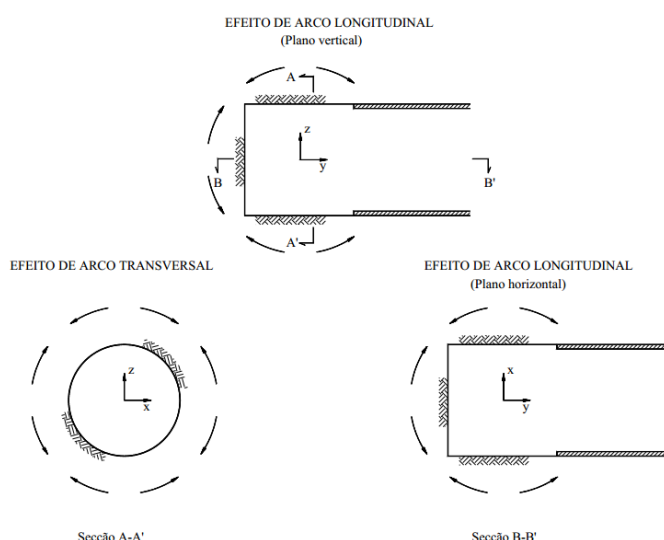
Efeito de arco tridimensional junto da frente de escavação de um túnel (Almeida e Sousa, 1998).
